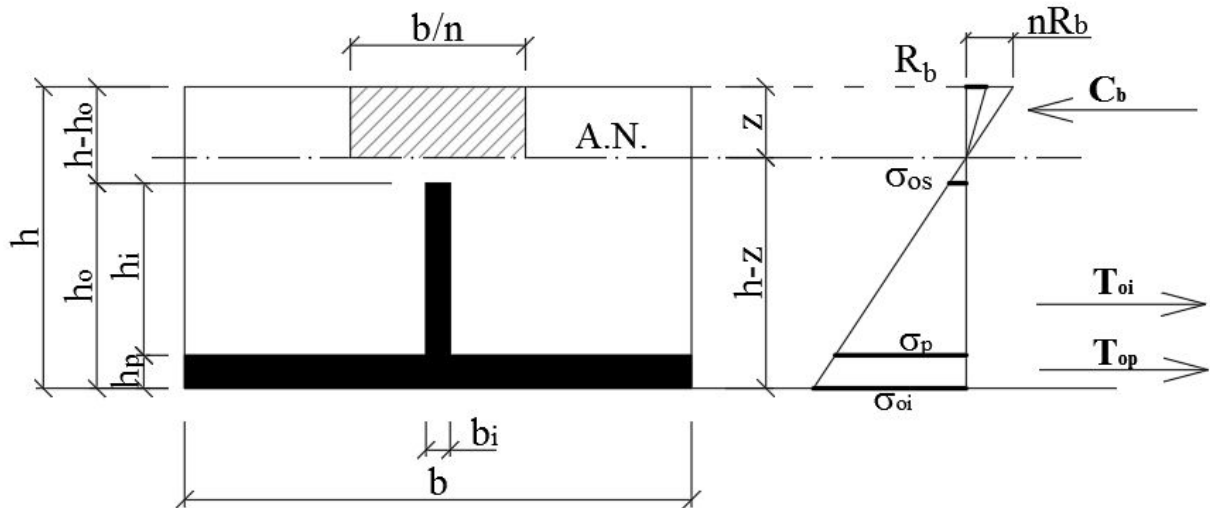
2. Model de calcul al structurii mixte oțel-beton cu structură metalică din platbenzi
